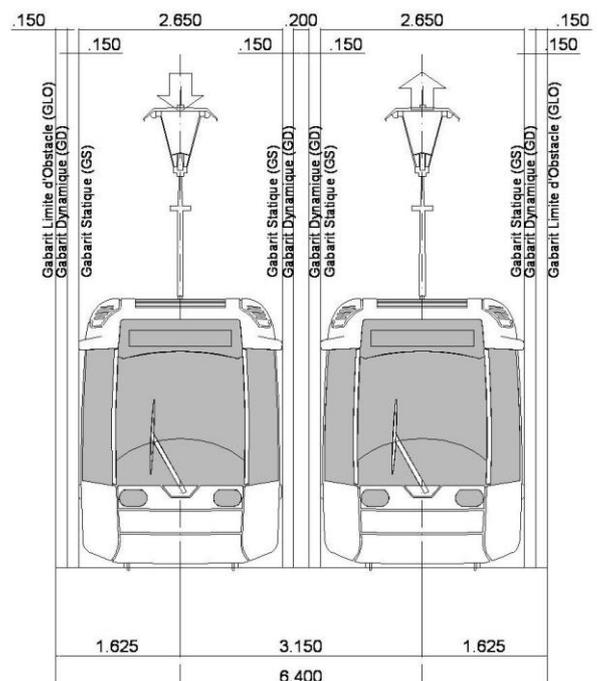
Coupe transversale du tramway en voie double avec poteaux latéraux.
